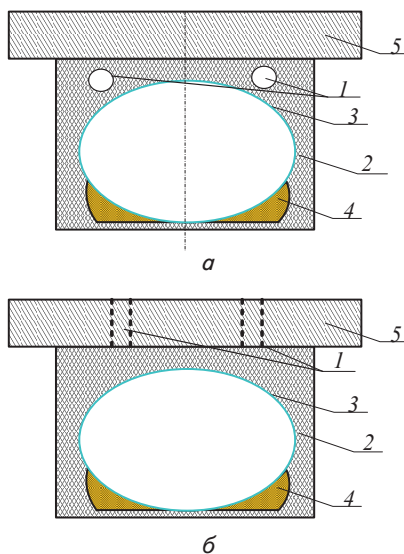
Отвори для подачі бетону: а – розміщені в торці опалубки; б – розміщені в площадці старого об'єкту: 1 – отвори для подачі (оглядові); 2 – опалубка; 3 – конструкція з гофрованого металу; 4 – подушка з піску, або гранвідсіву; 5 – плита площадки об'єкта, який ремонтується
